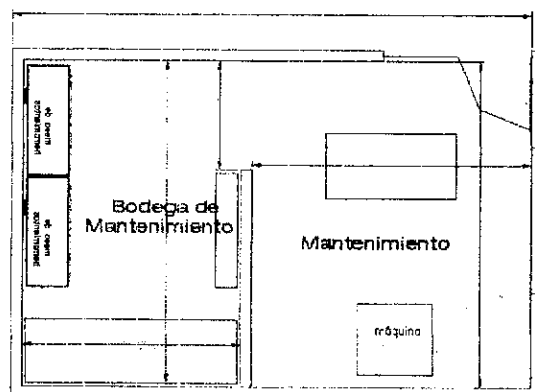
PLANO ÁREA DE MANTENIMIENTO
